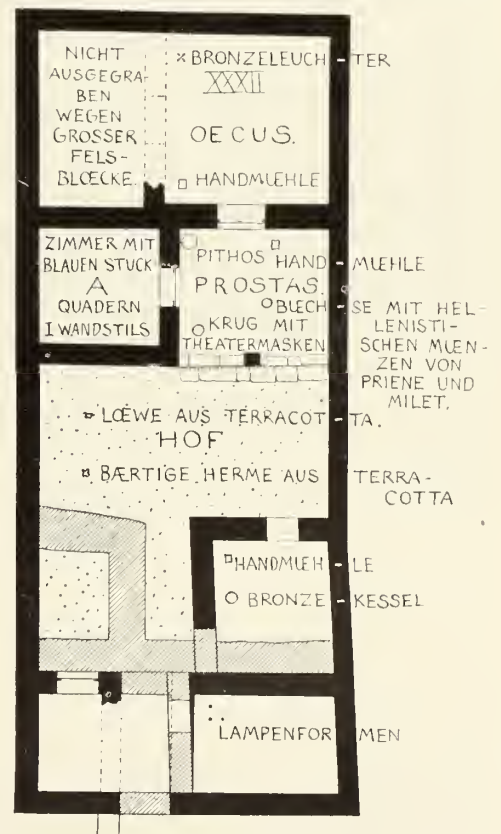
Grundriss des Hauses Nr. XXXII.
